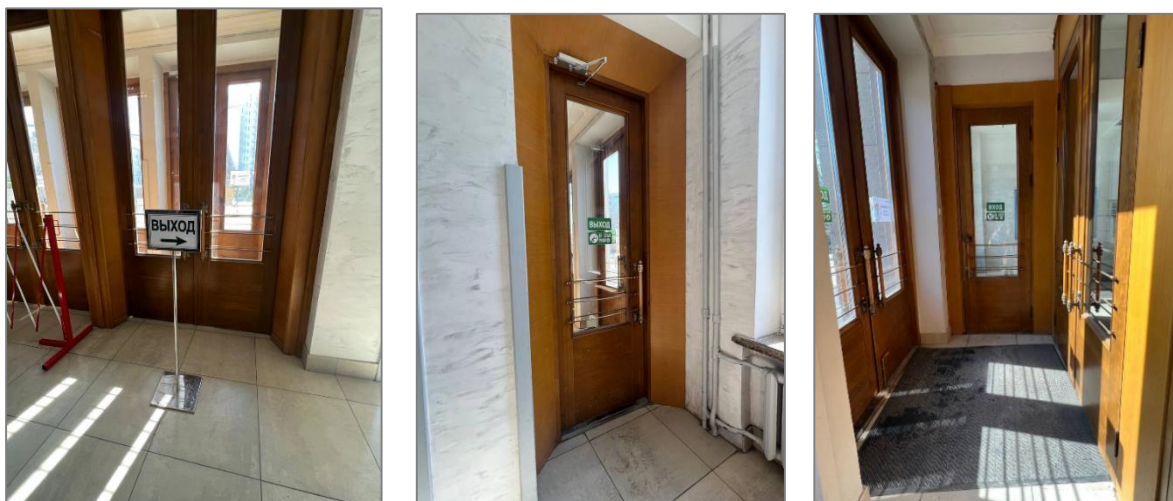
Выход из главного корпуса БГУ со стороны внутреннего двора
